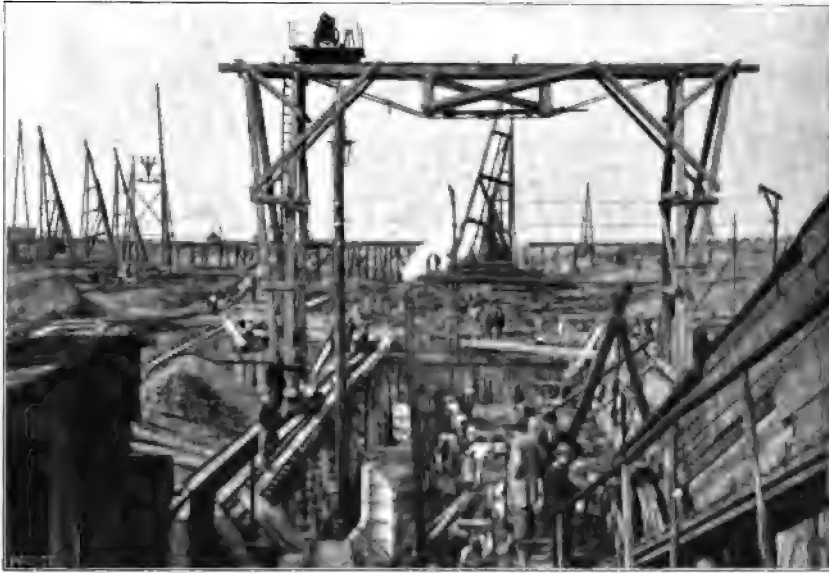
Baugrube des Oberhauptes der großen Schleuse in Bremerhaven.
